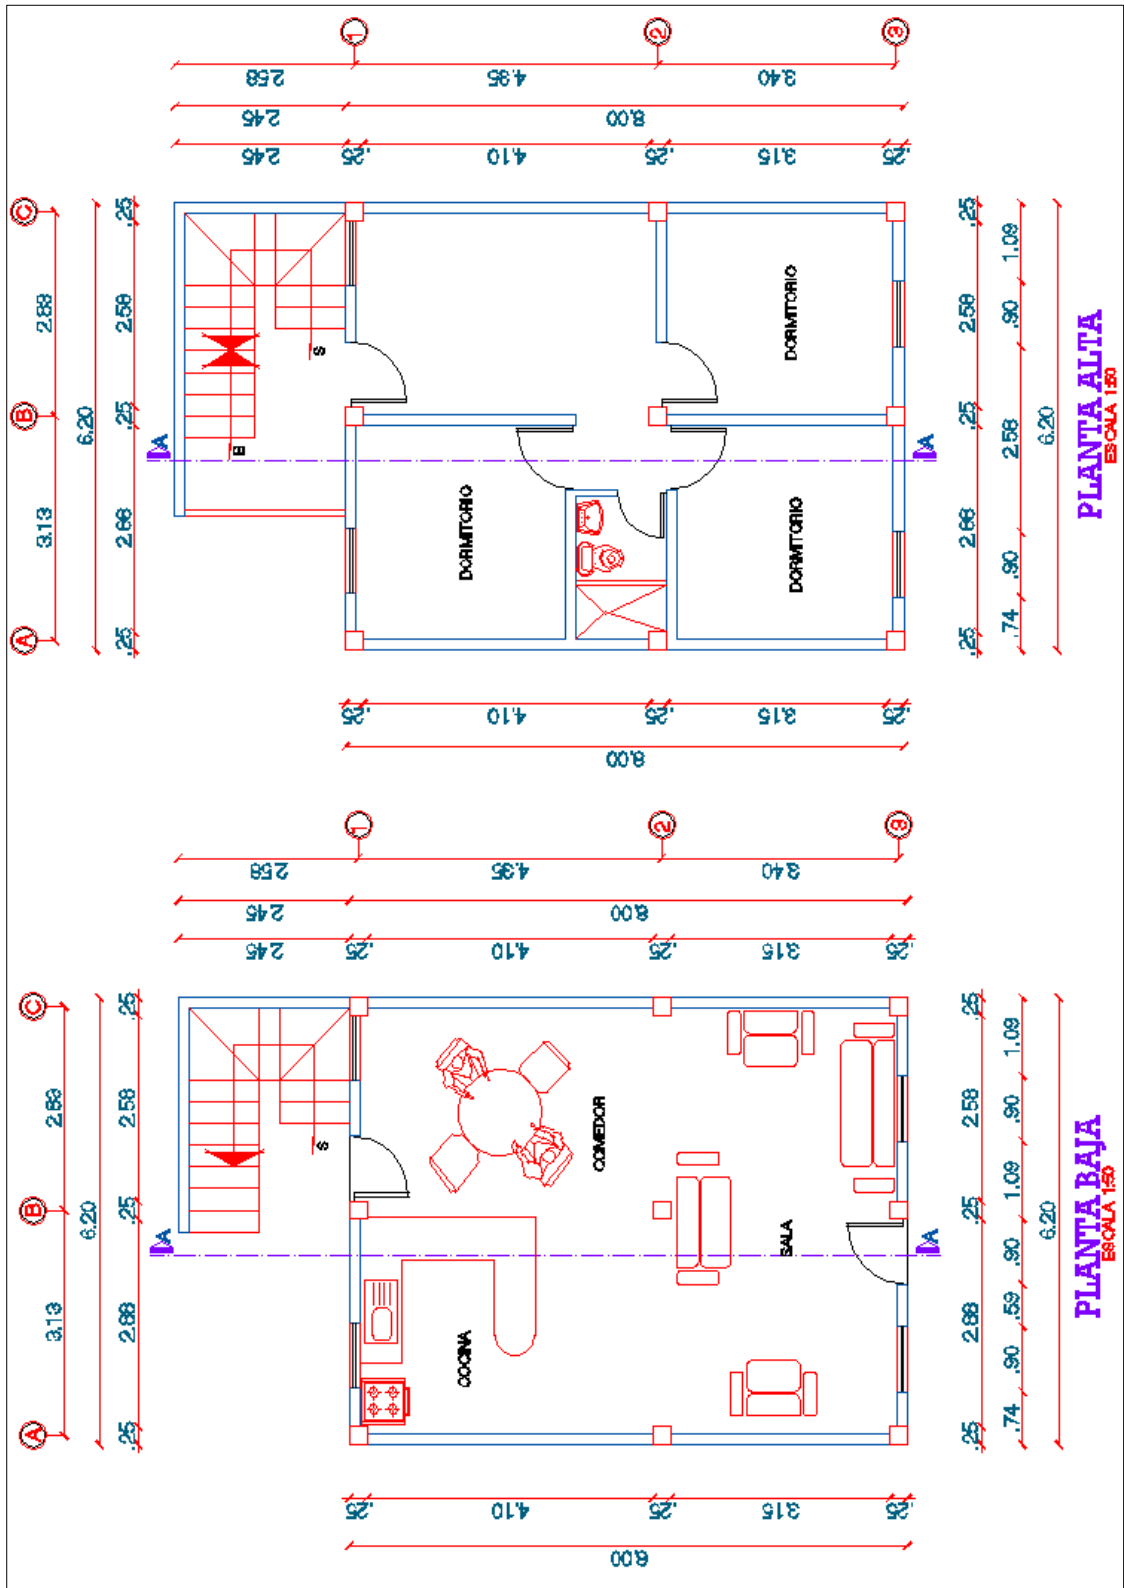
Modelo arquitectónico propuesto de vivienda unifamiliar - Planta.
